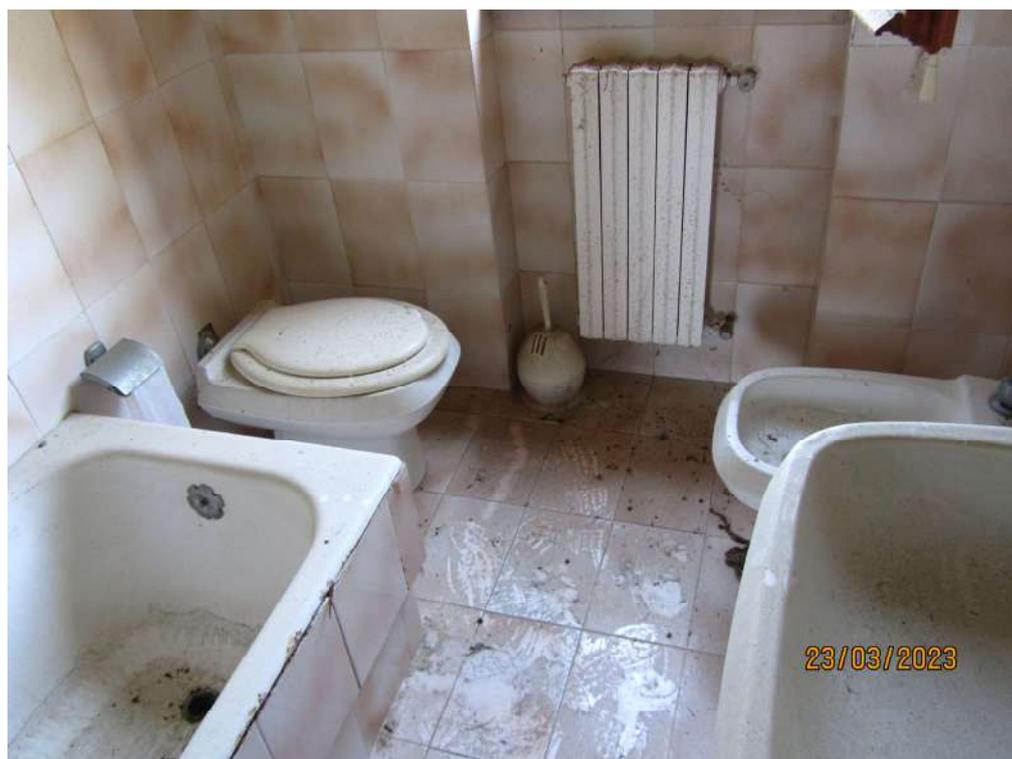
Bagno 2. Particolare stato manutenzione vasca.
